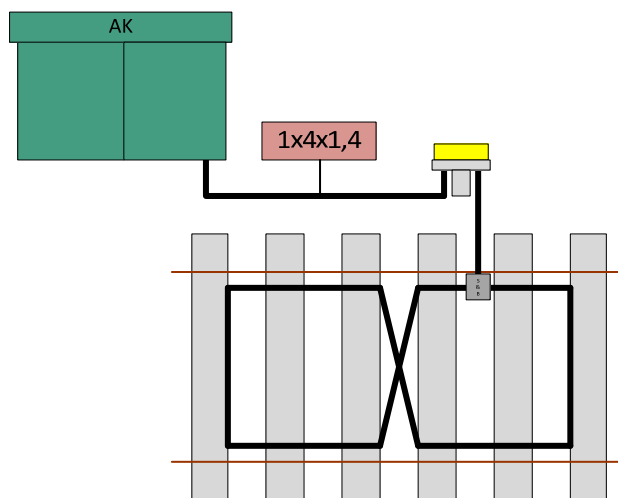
kabels tussen S&B schakelkast en drukknop
